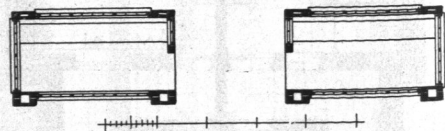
Wartehalle an dem Landungssteg Lombardsbrücke, Grundriß.
